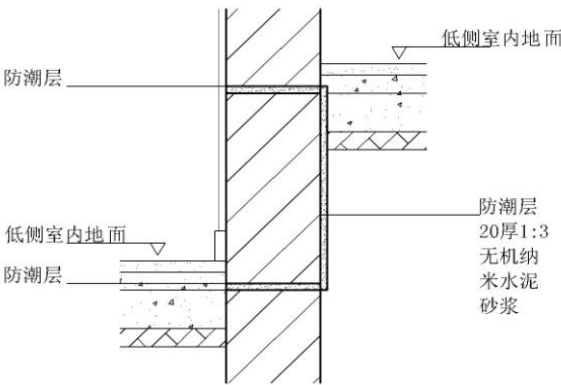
高性能抗裂防水砂浆在KP1多孔砖、普通砖高低差墙角施工图
